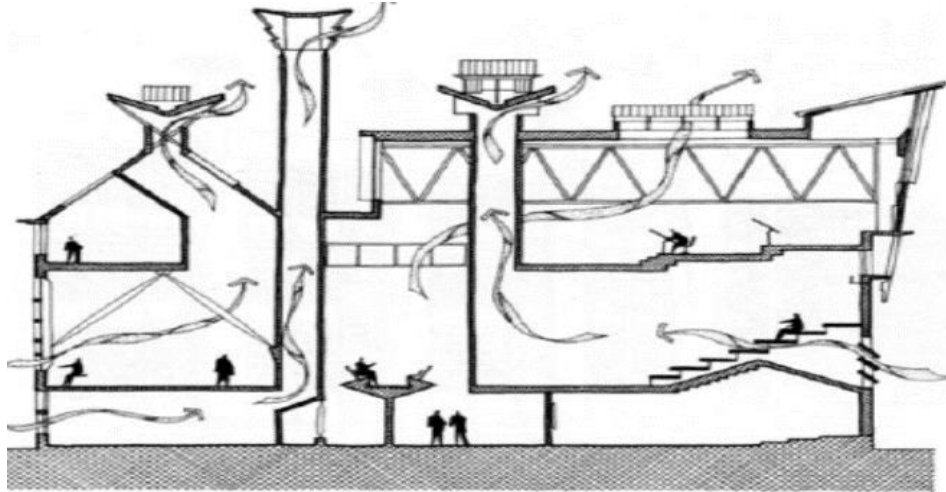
Section d'un bâtiment ventilé naturellement[3]
